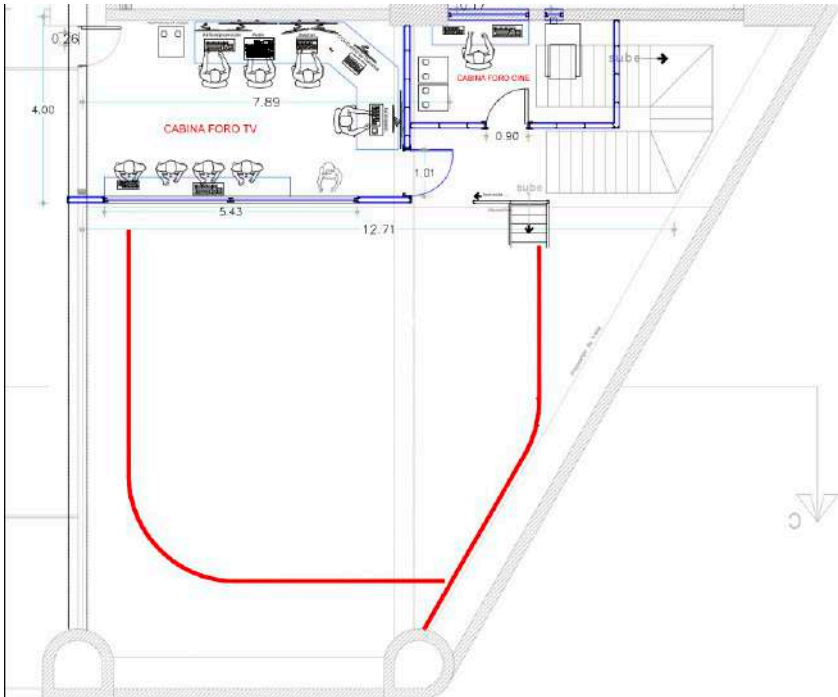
| SISTEMA DE RIELES PARA CORTINA PERIMETRAL
